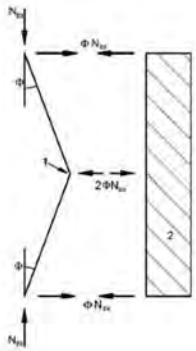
Forze equivalenti nelle giunzioni di elementi o piattabande compresse
